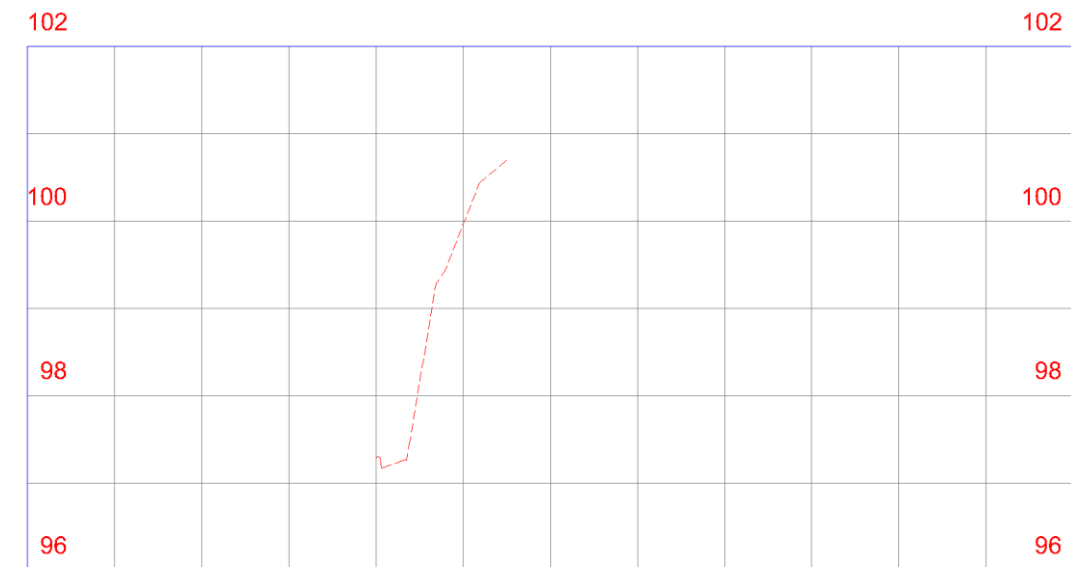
Perfiles de terreno. Fuente: elaboración propia.
